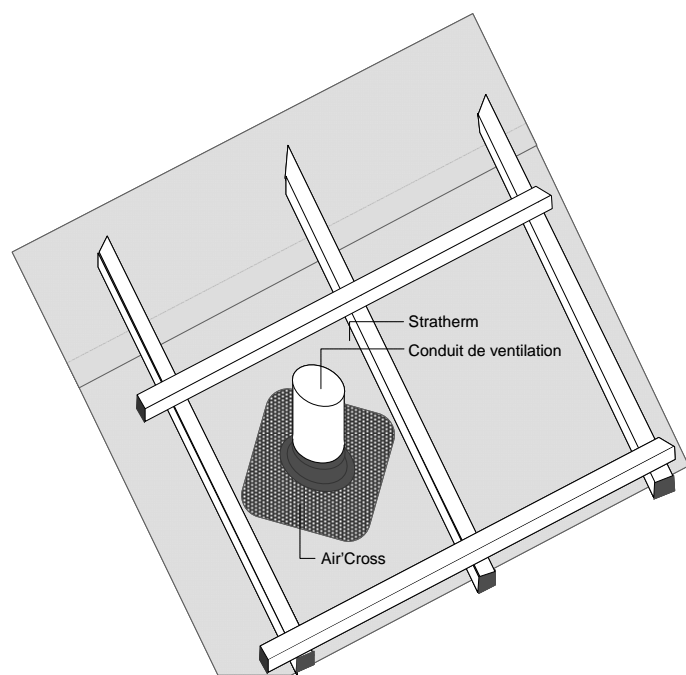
Raccordement d'une sortie de conduit de ventilation à l'aide d'une manchette Air'Cross
